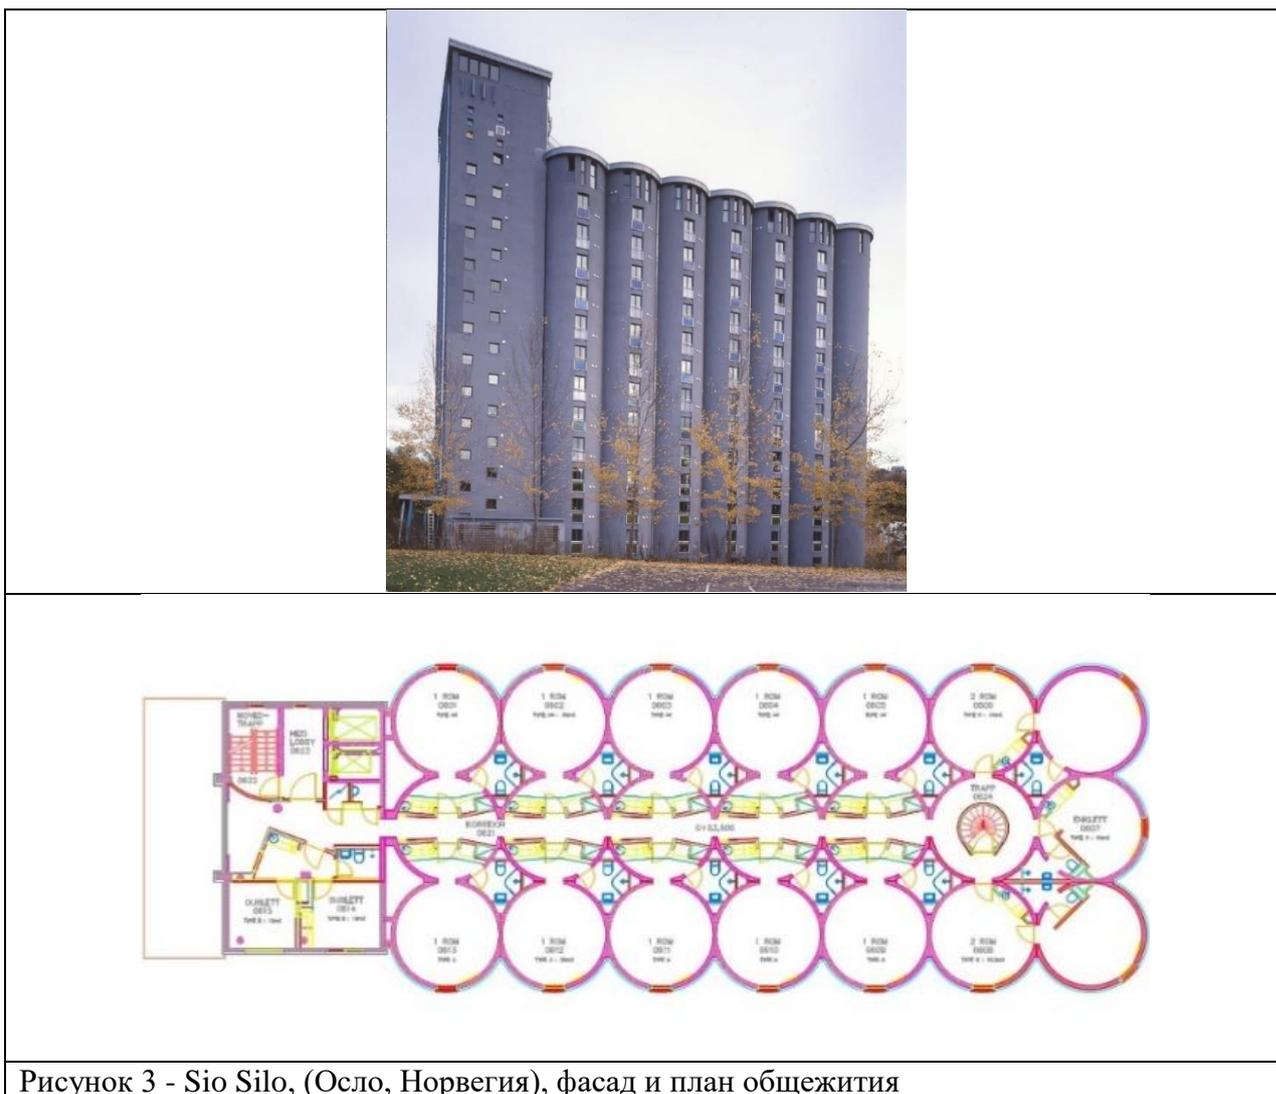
Sio Silo, (Осло, Норвегия), фасад и план общежития
